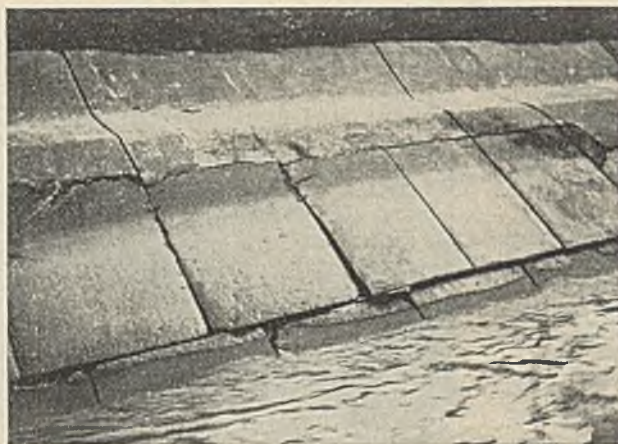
Lagenänderung von Betonplatten bei zu großer Schleppkraft.
